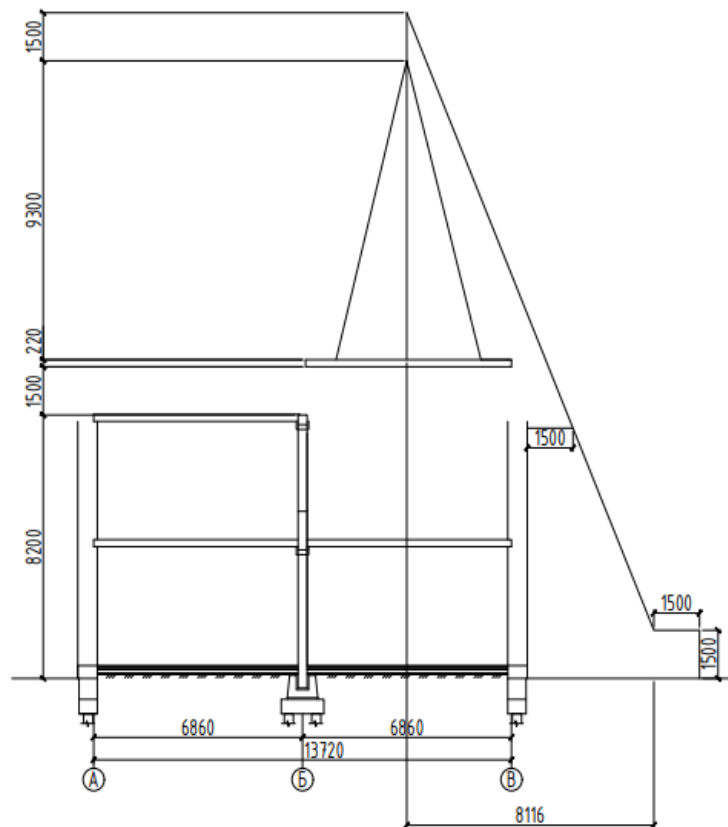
Схема работы крана при монтаже плиты перекрытия
